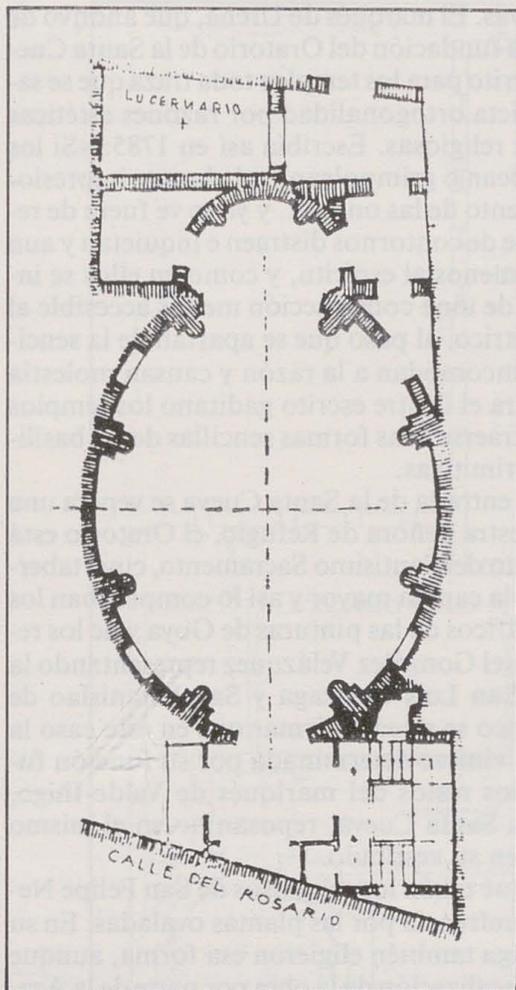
Planta de la iglesia de la Santa Cueva (Cádiz).
